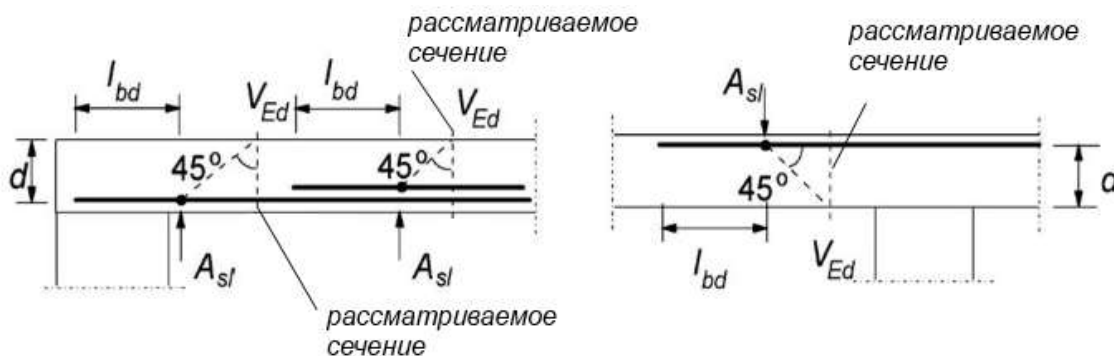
К определению площади растянутой арматуры A_{sl}
